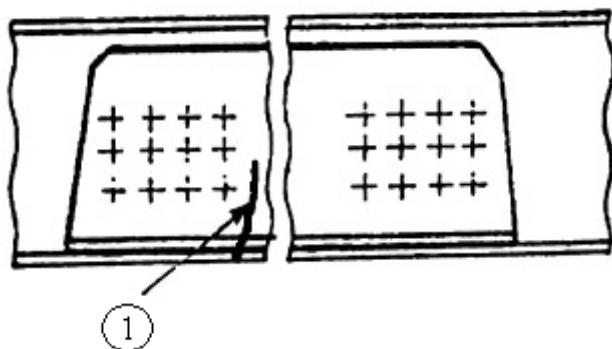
Балка, усиленная накладками, в месте расположения упорных угольников
